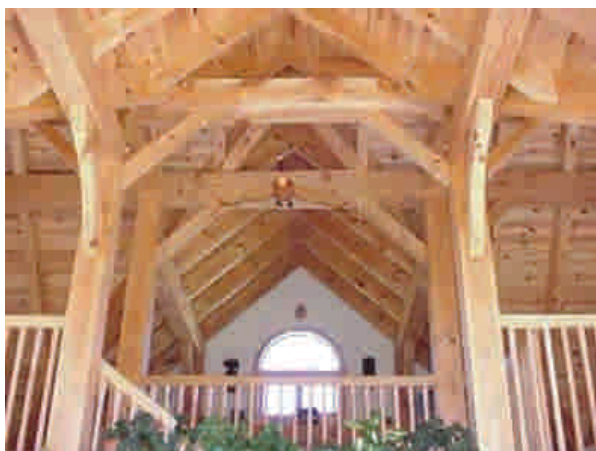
7: Conjunto de elementos estructurales, vigas y pilares a la vista en el interior.
